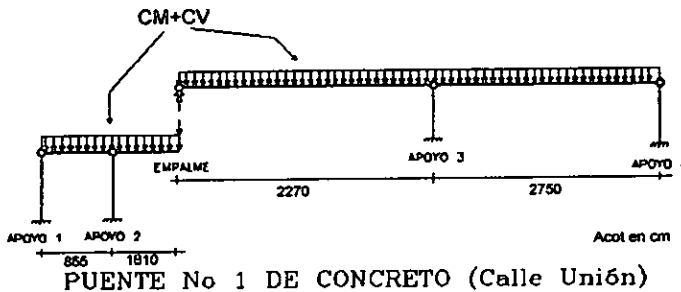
Modelación del Puente No 1 para la bajada de cargas.
